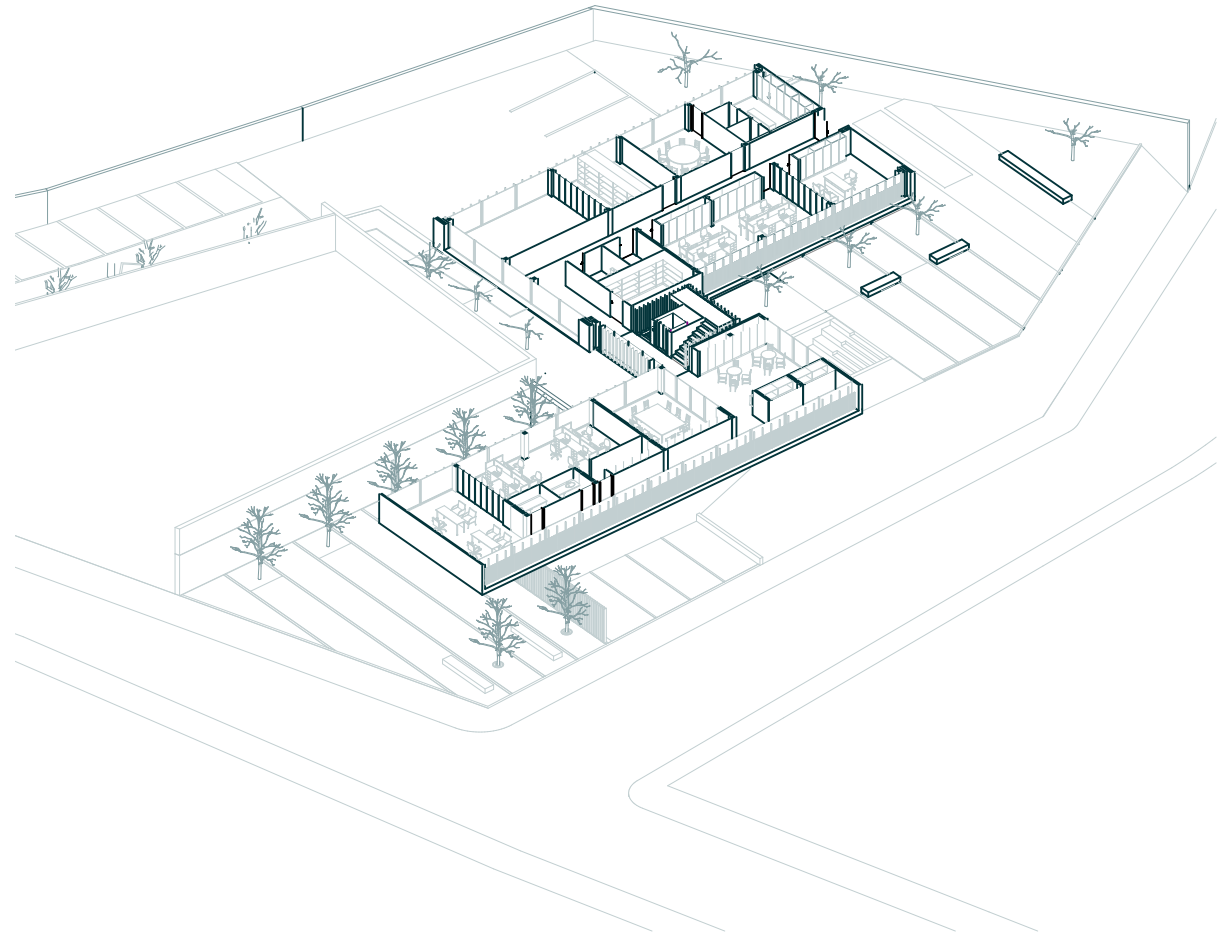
Axonometría de Primera Planta Alta (Autores, 2023)
